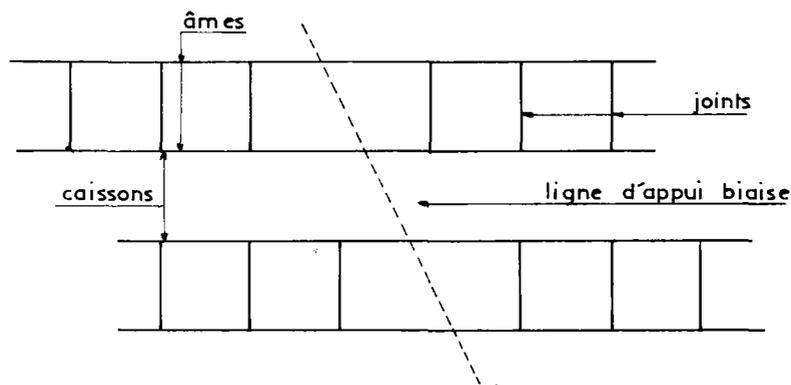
Découpage des voussoirs (en plan) pour un ouvrage biais à deux caissons.
